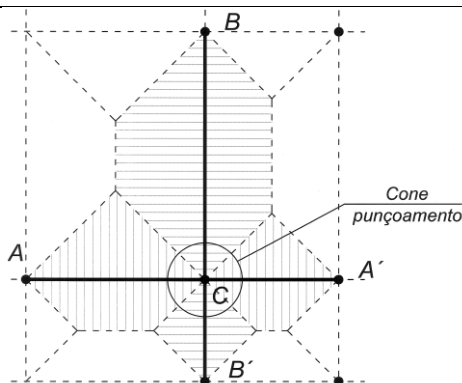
Esquema de vigas que ligam os pilares entre si.
